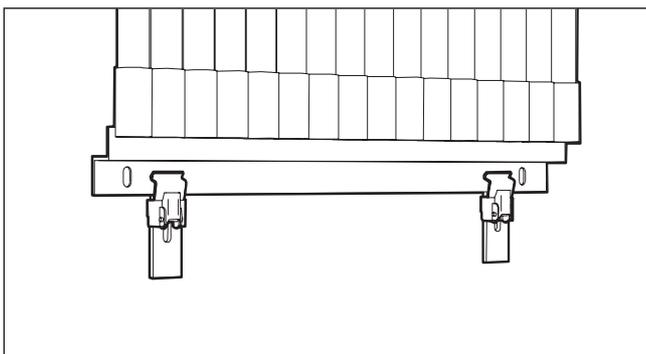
Нижняя пара настенных крюков для монтажа на фасаде
